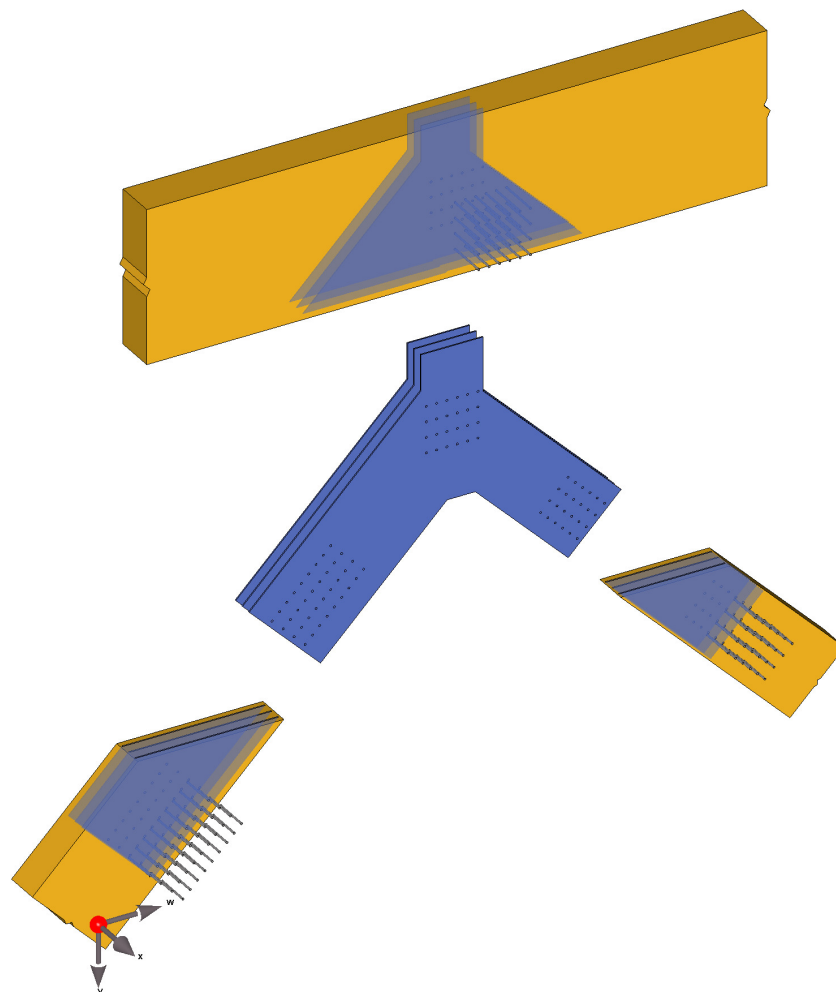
Explosionszeichnung des Anschlusses für Fachwerk FB3.j
